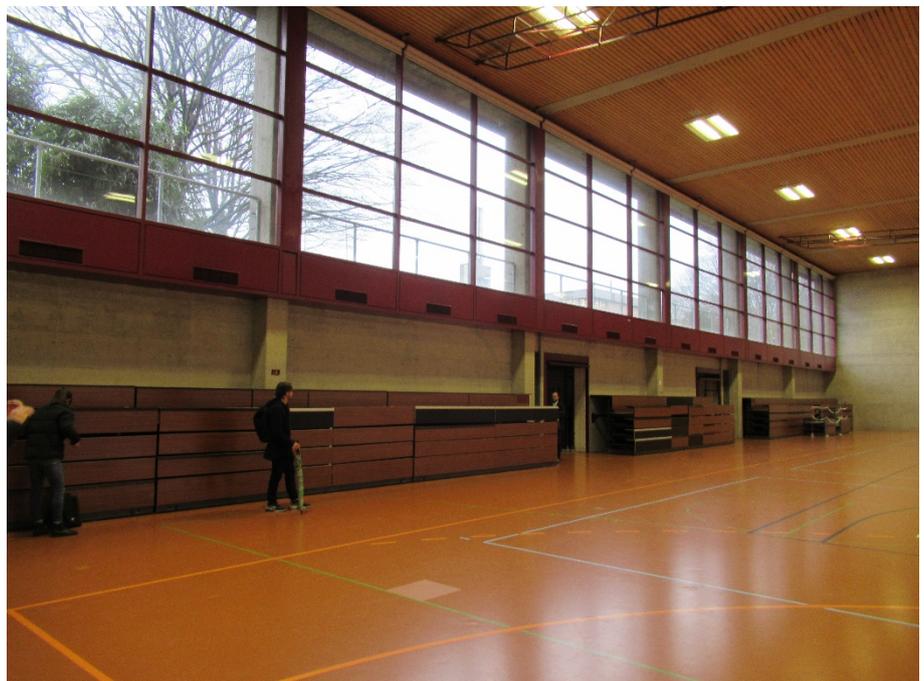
Südfassade der Sporthalle, Deckenunterzüge aufgelagert auf Stützen, im unteren Bereich Stützen mit Betonwand ausgefacht. Dahinterliegend Geräteraum.
